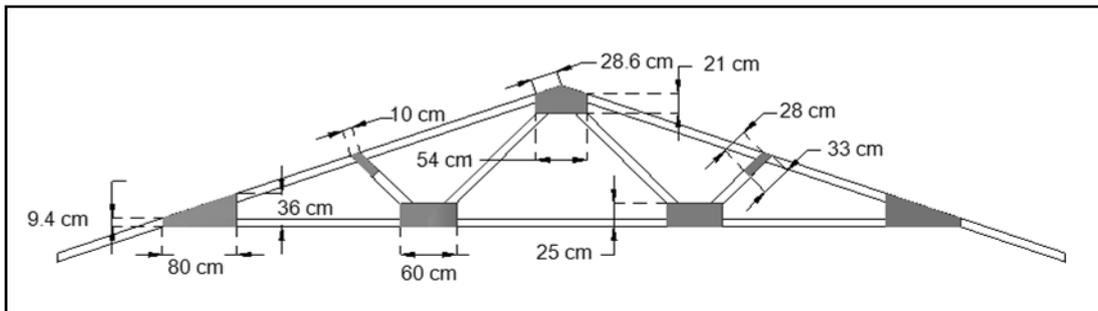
Dimensiones de las cartelas de tablero contrachapado de 12 mm (UF).
